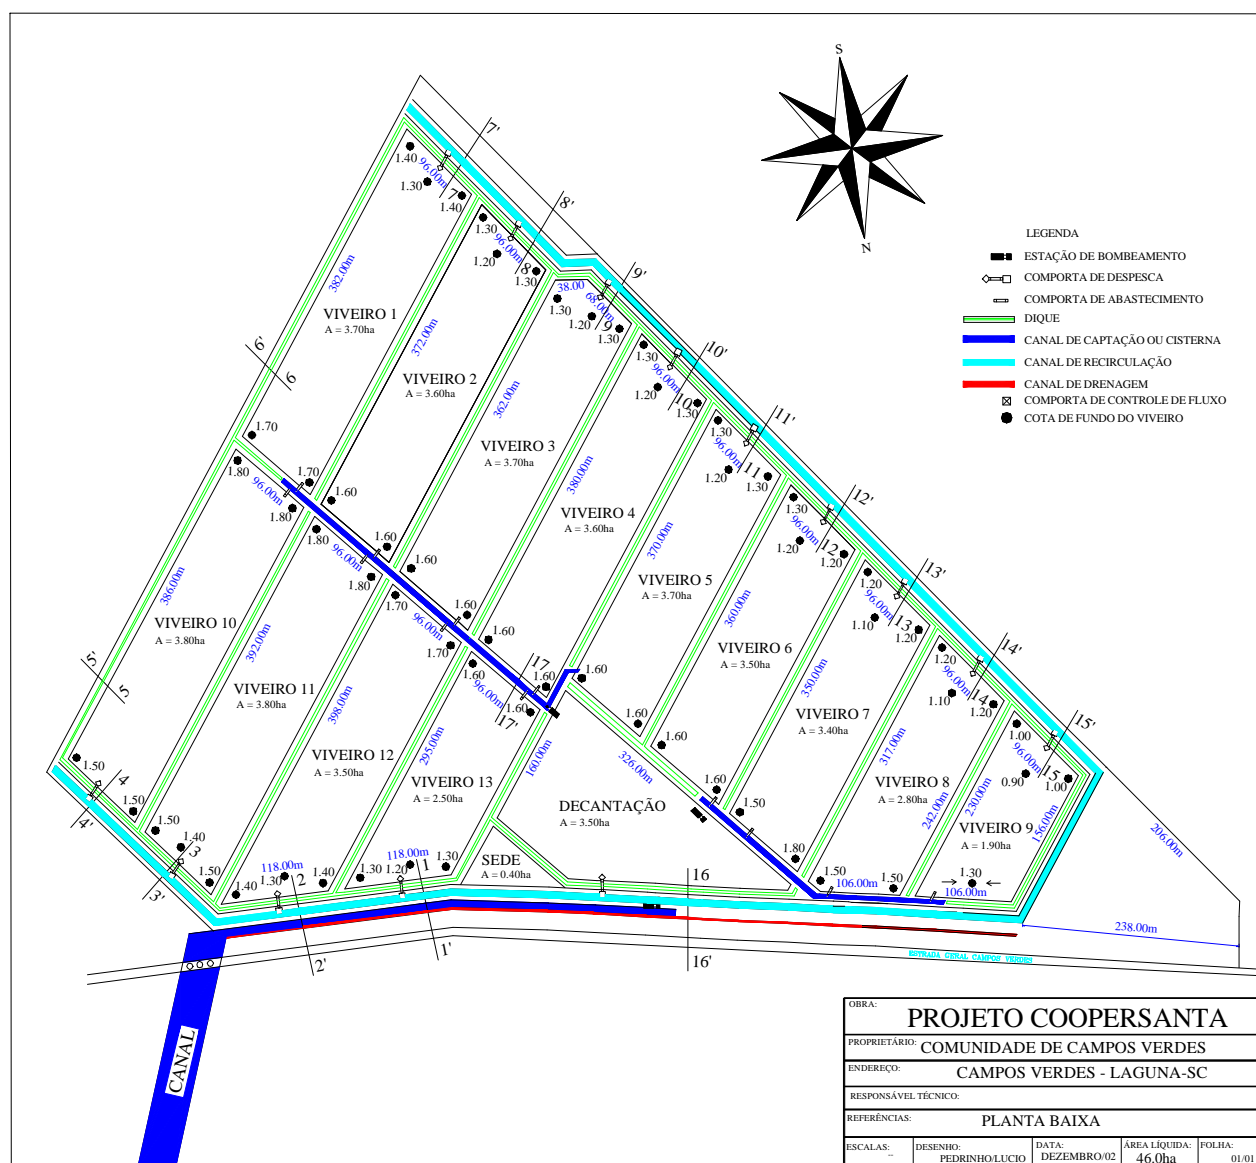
Planta baixa, projeto COOPERSANTA Módulo I. Distribuição dos viveiros, canais de drenagem e recirculação, comportas de drenagem e abastecimento e canais de abastecimento. PEDCC.
